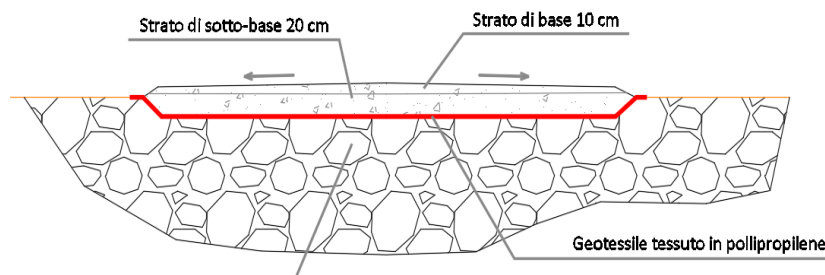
Sezione trasversale tipo della viabilità interna al sito
